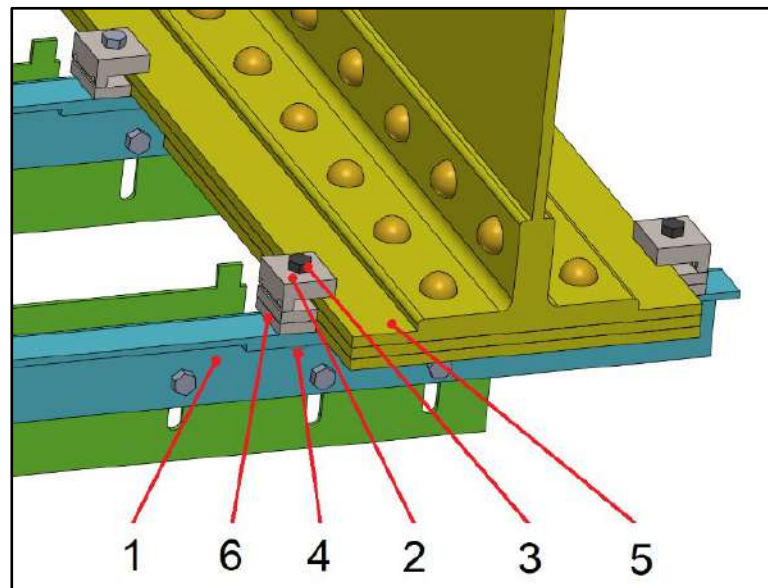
Vista en perspectiva de la unión de la Viga en L al perfil del cordón longitudinal mediante las correspondientes grapas y piezas de nivelación.
